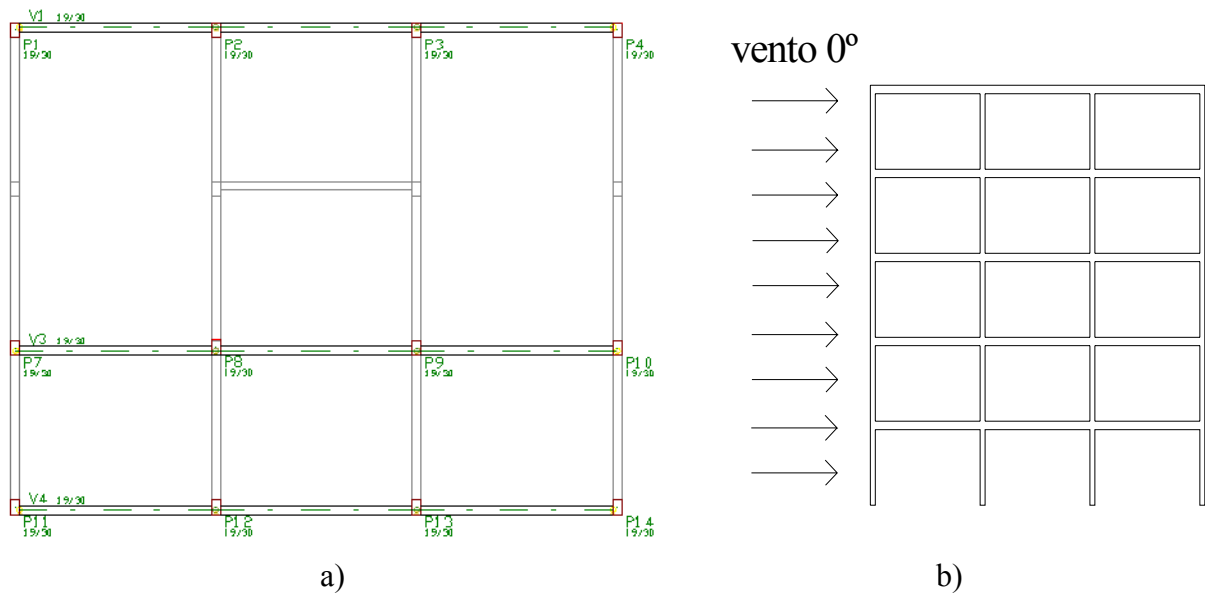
Pórticos planos: a) em planta; b) vista frontal
